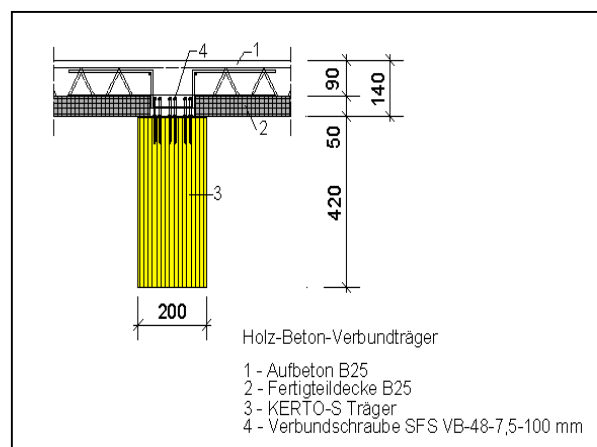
Holz-Beton- Querschnitt bei der Schule Lemgo, Spannweite 8,1 m, Balkenabstand 2,32 m nach [36]
